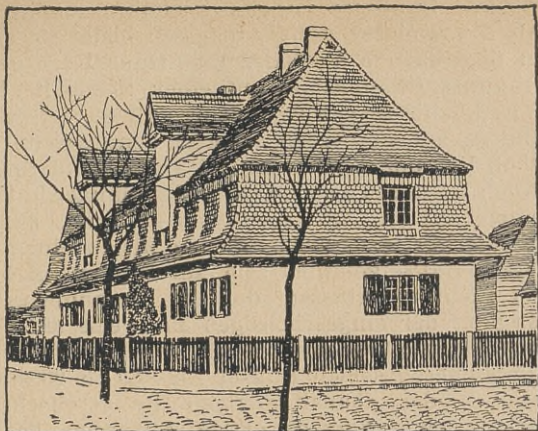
Haus der Gartenstadt Stockfeld b. Straßburg.
